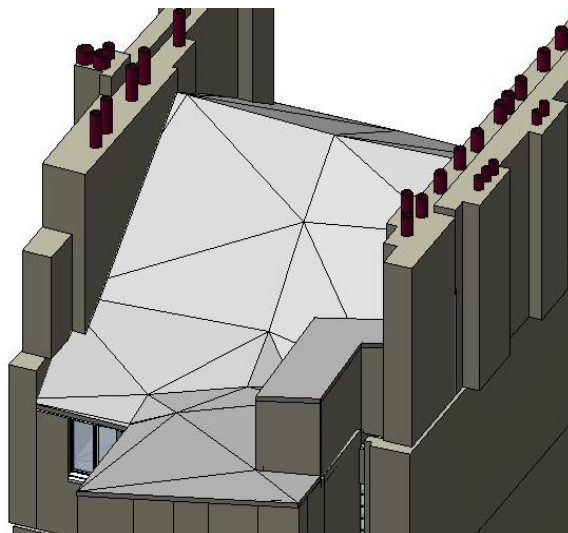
modélisation d'un toit sur Revit où chaque intersection de lignes est un point de niveau.
